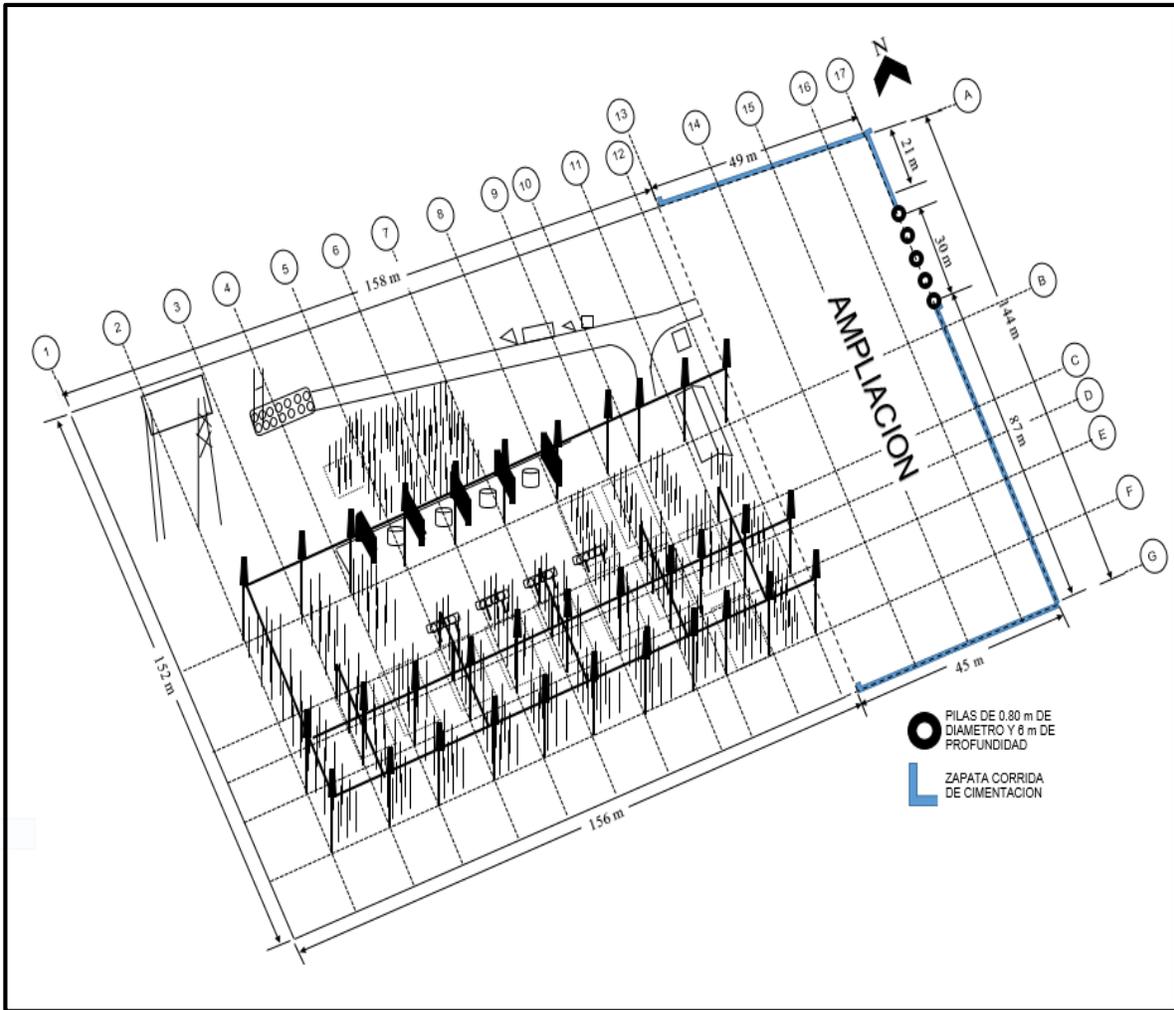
Ubicación de la pilas y zapata corrida para Cimentación de la Barda Perimetral
